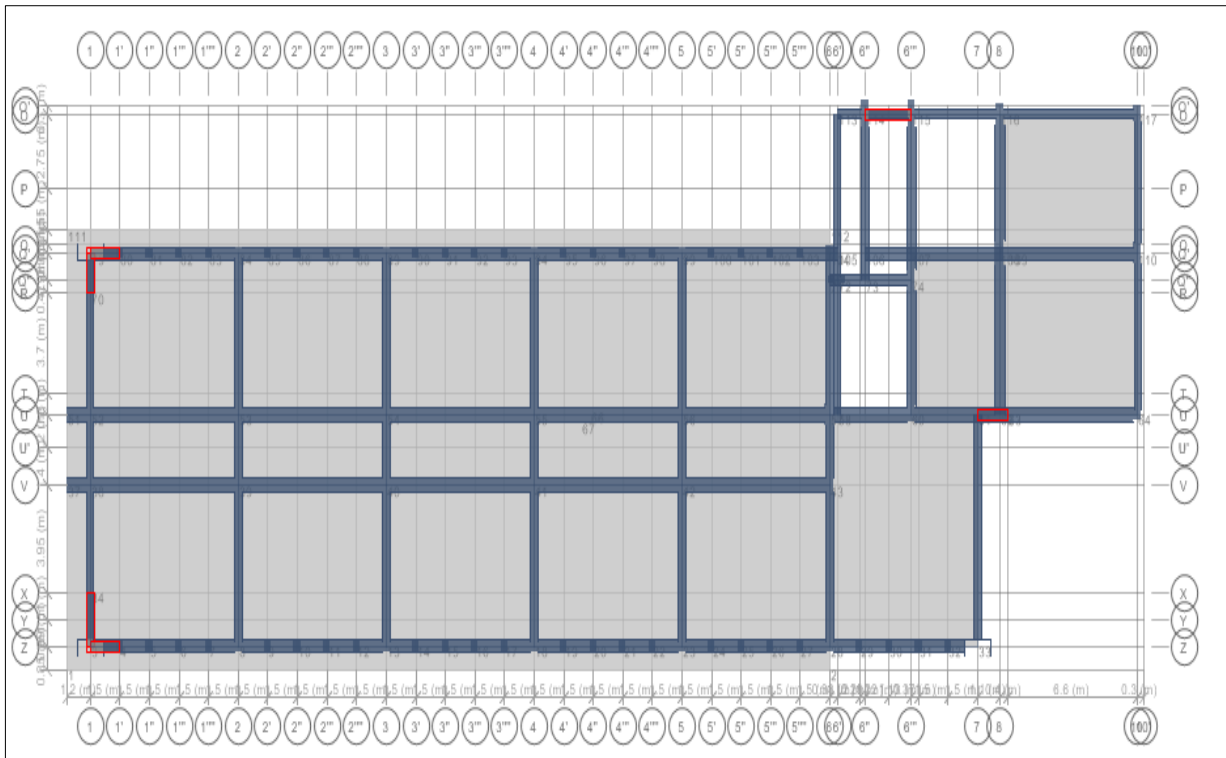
Planta estructural N+10.80 Estructura 5.1
